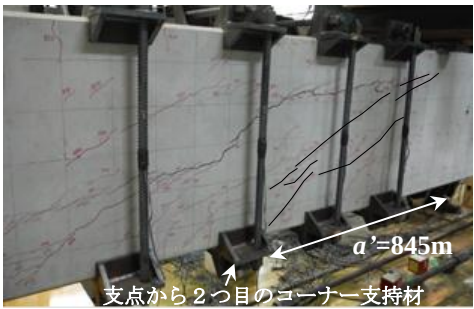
No.1 の最大荷重時のひび割れ発生状況
